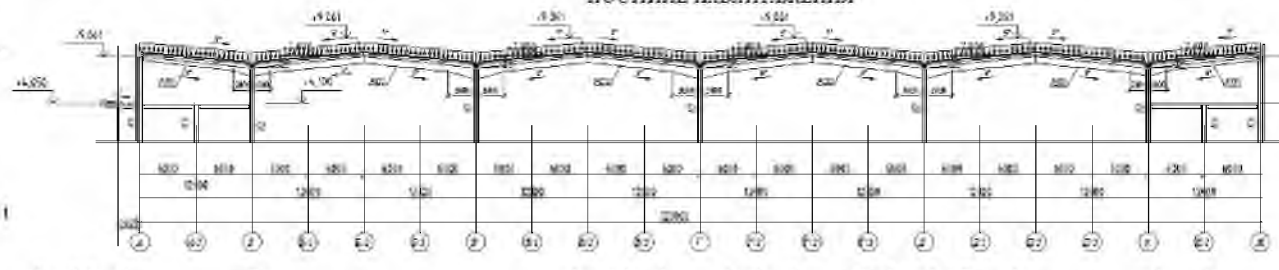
Схема постійного навантаження на поперечну раму будівлі
